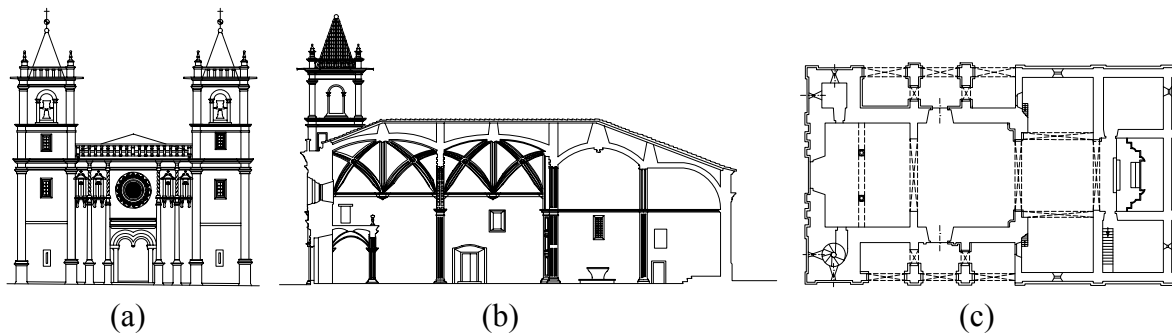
Geometria da igreja, (a) alçado, (b) corte longitudinal e (c) planta
